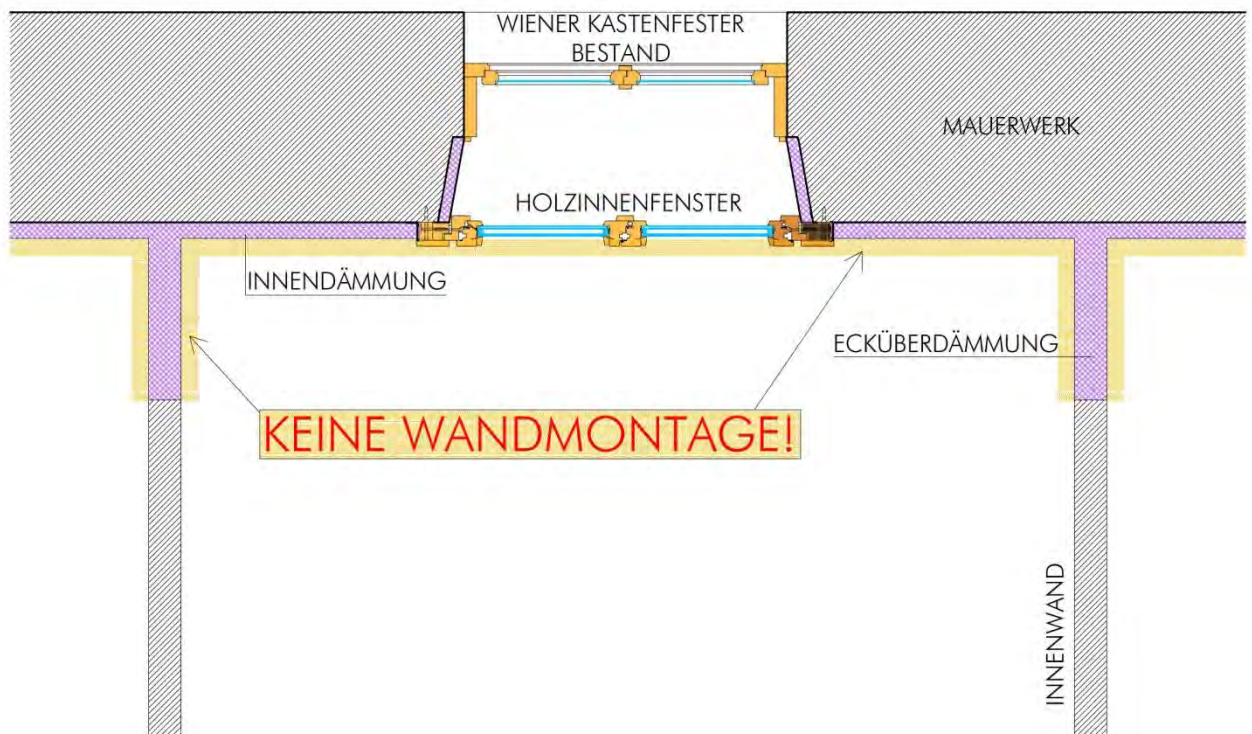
Lageplan: Denkmalgeschützte Fassaden mit Innendämmung – keine Wandmontage!
